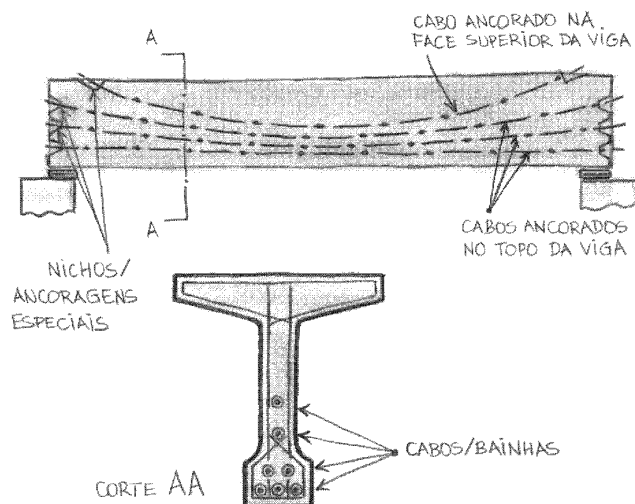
Exemplo de aplicação: protensão com aderência posterior
